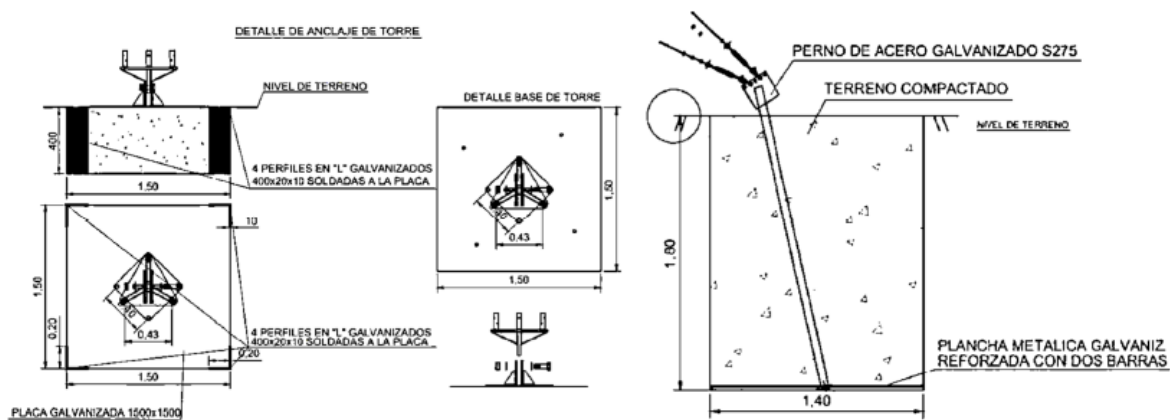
Cimentación, anclaje central y anclaje de cables de la torre arriostrada
